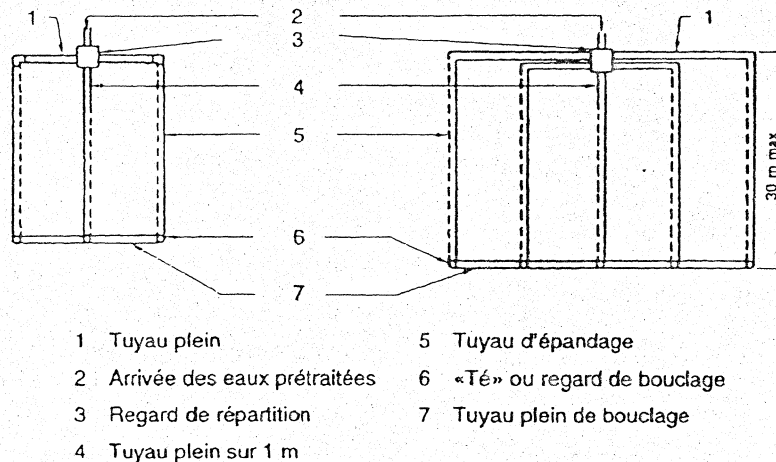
Vues en plan ; exemples à 3 et 5 tranchées
